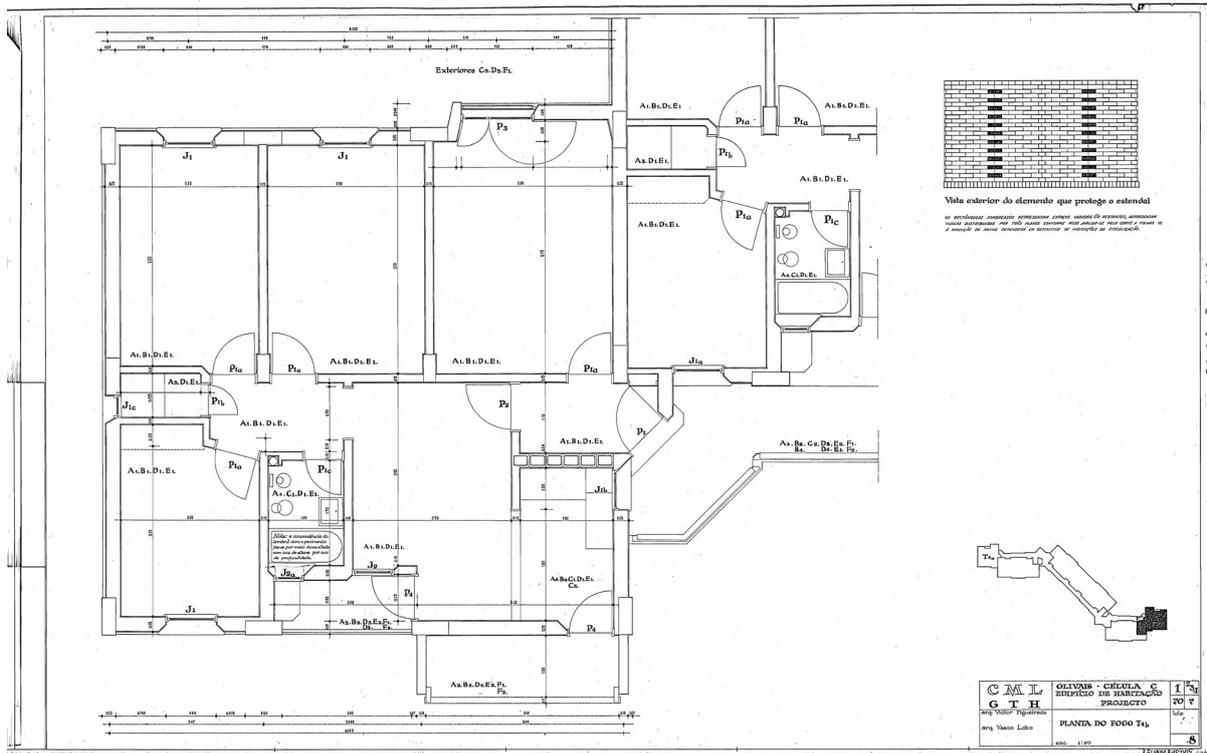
Projeto: lote 29, planta do fogo T4B
